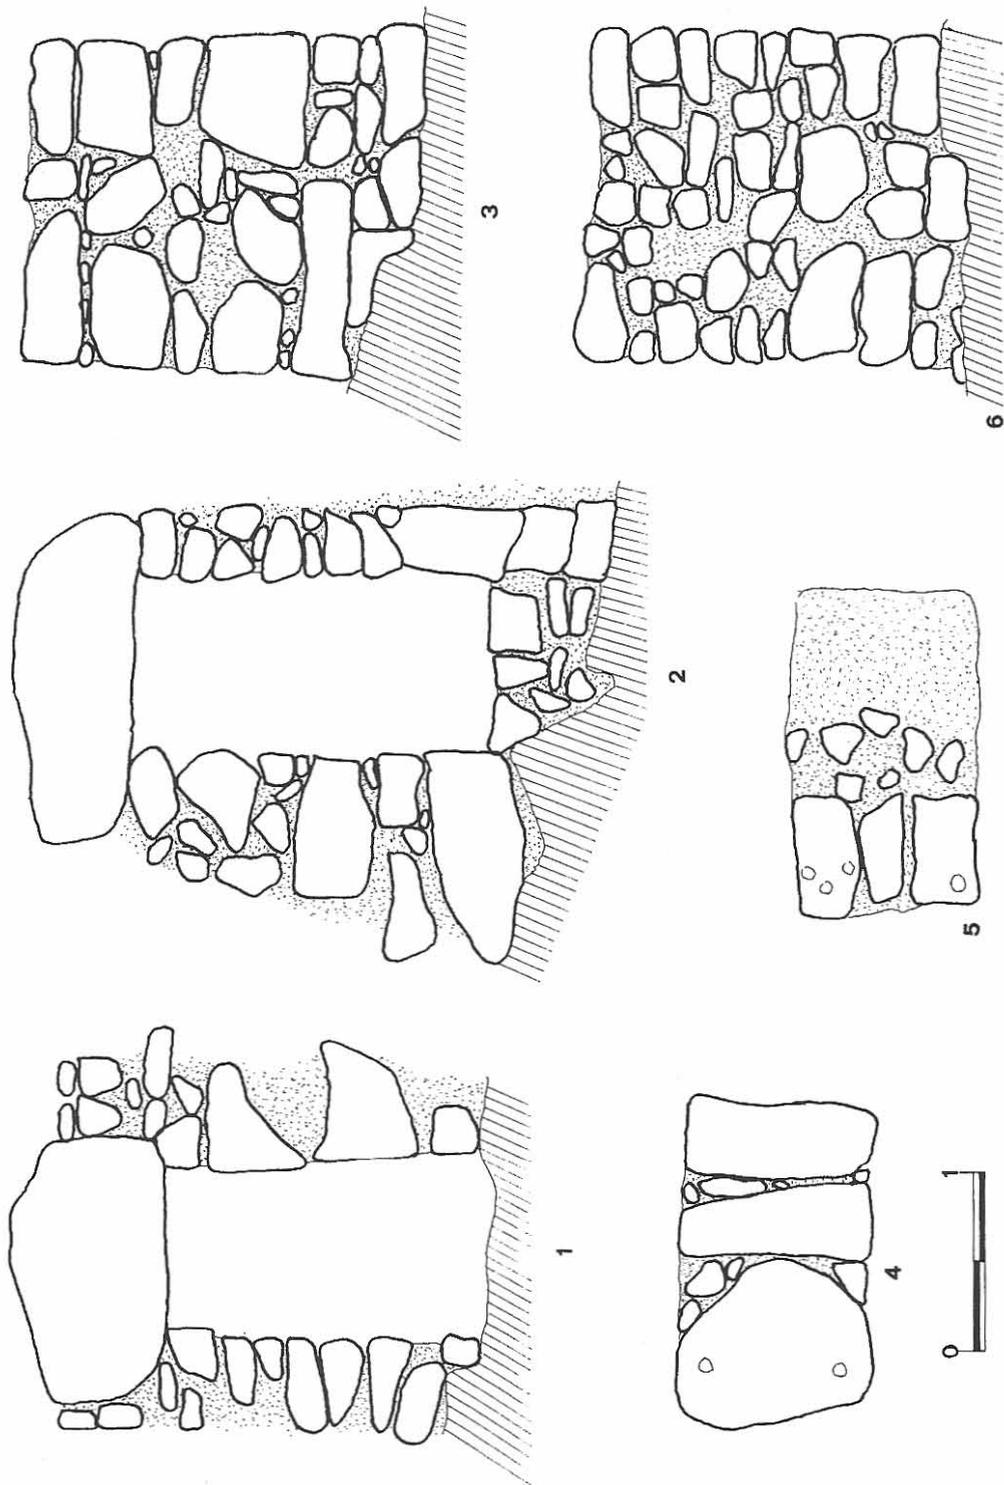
Portillo. nº 1.- alzado interior; nº 2.- alzado exterior; nº 3.- alzado de la pared interior norte; nº 4.- alzado de la parte superior, adintelada, con los tres grandes bloques de granito y huellas de las gorroneiras; nº 5.- suelo con huellas de las quicaleras; nº 6.- alzado de la pared interior sur.
